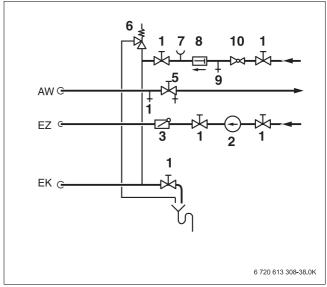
Installation und Ausrüstung der Trinkwasserleitungen
